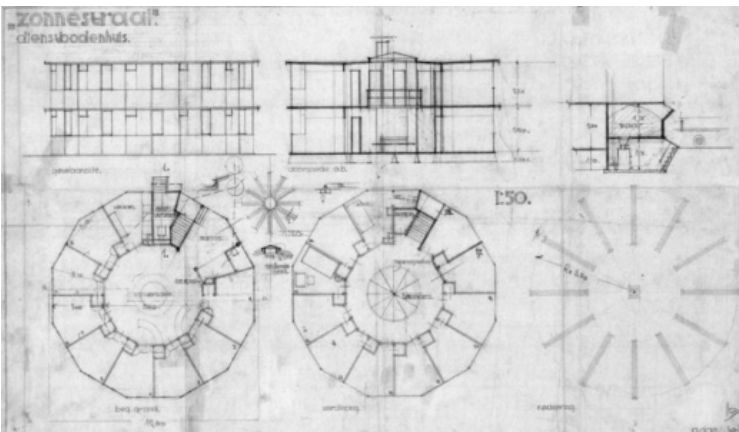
Planos de las plantas de Proyecto de Escuela al aire libre para Zonnestraal. Realizado por J. Duiker y B. Bijvoet entre 1925 y 1926. Maqueta y planta (Jelles, Alberts 1972: 65).
